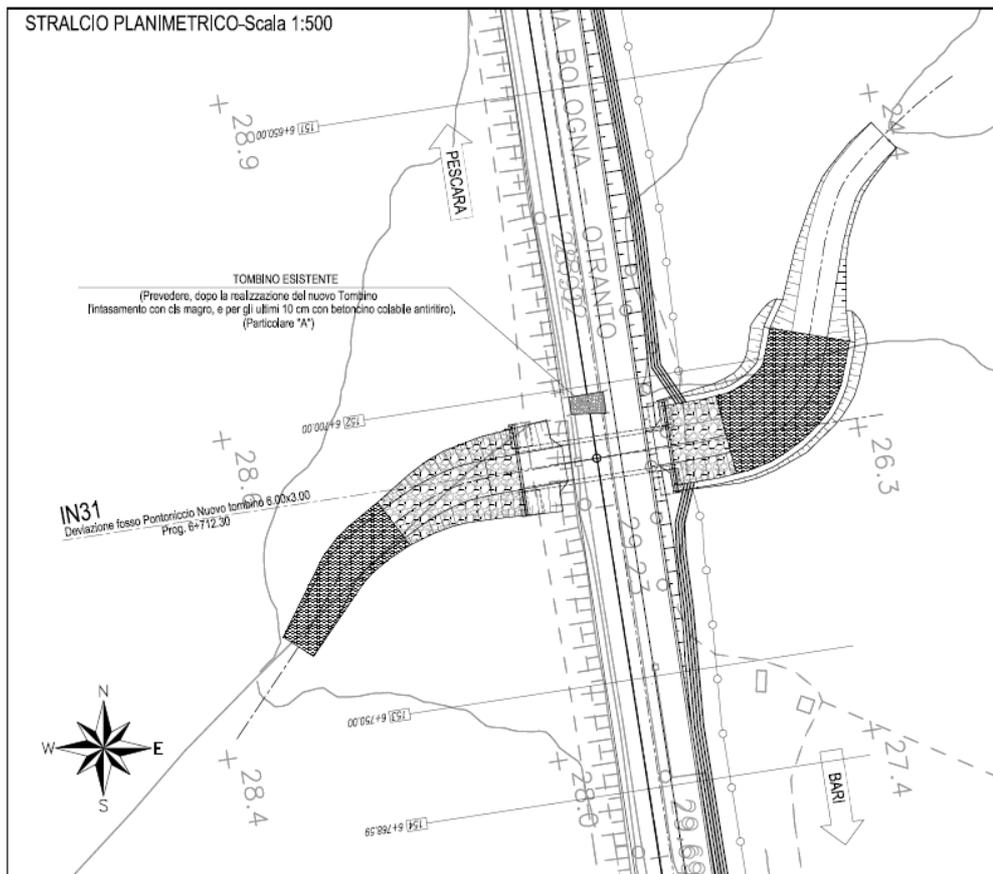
Scatolare km 6+712 – Vista Planimetrica
